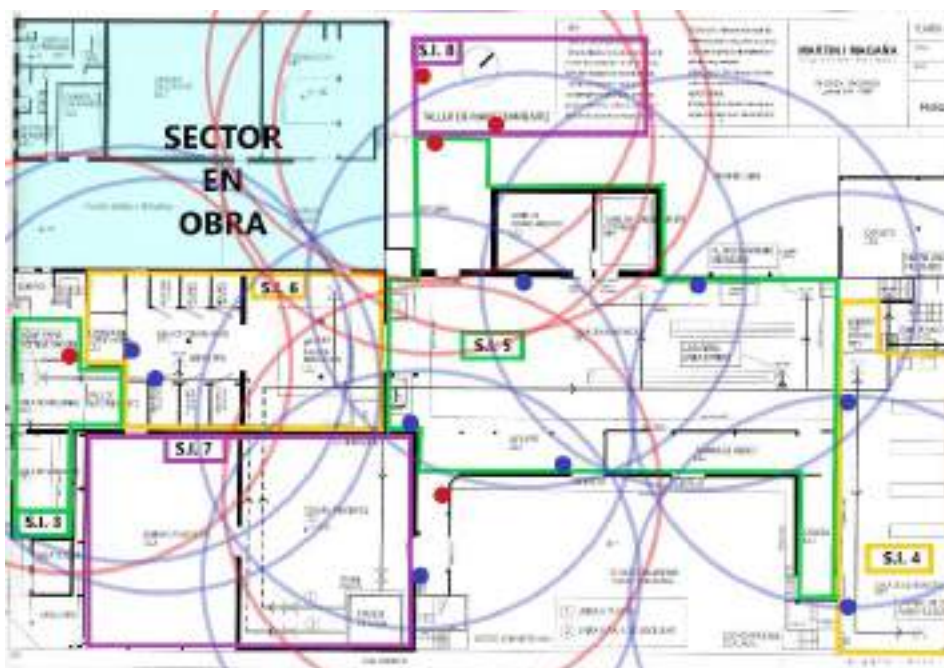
Ilustración XVI: Ubicación de S.I., extintores y radios de alcance en planta baja
